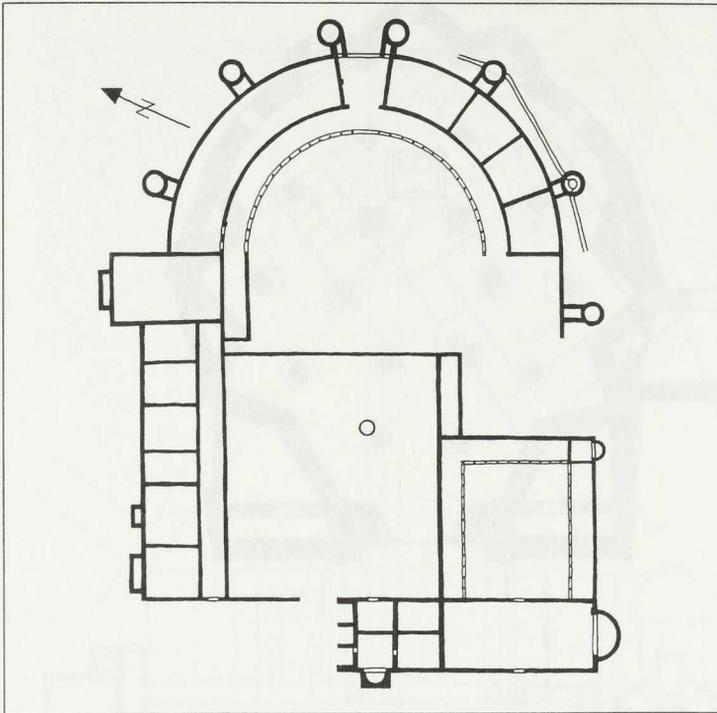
Ingelheim, Pfalz, Grundriß (nach Binding)
